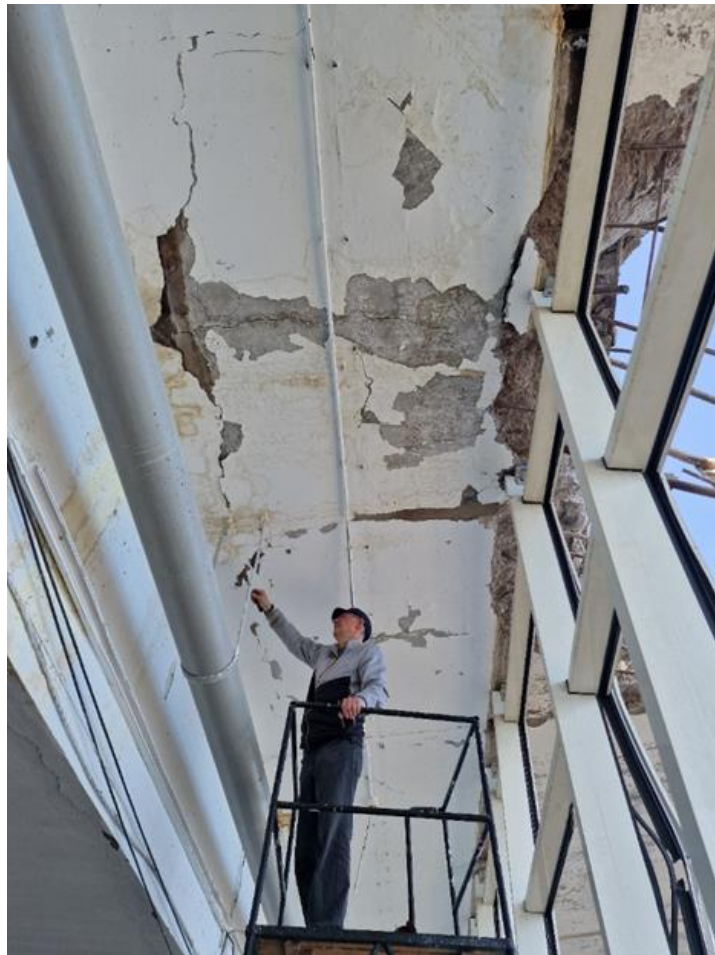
Характерне після ракетного удару тріщиноутворення, тріщини вздовж ригеля в залізобетонній плиті покриття будівлі
